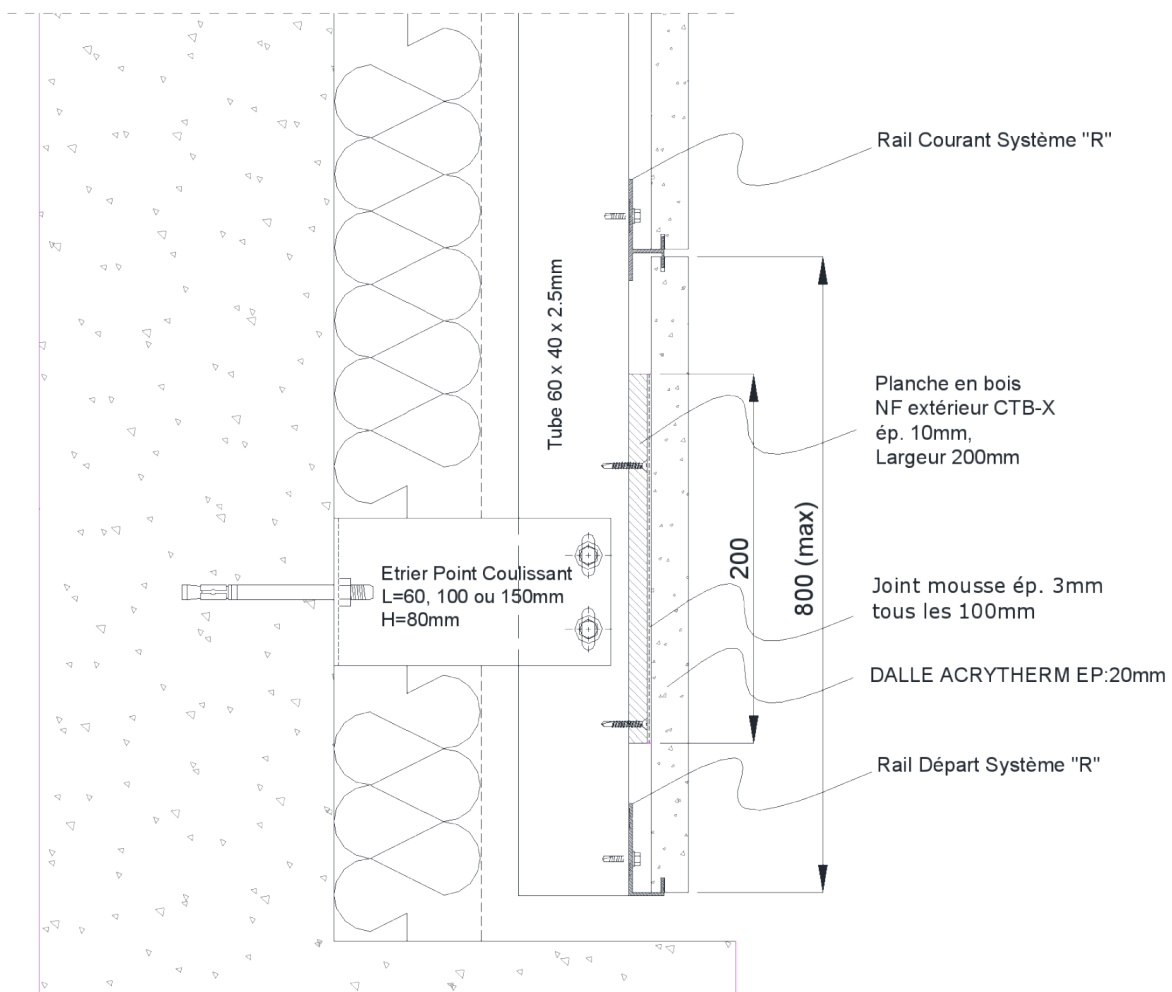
is – Coupe verticale – Plaque renforcée pour rez-de-chaussée exposés aux chocs extérieurs de classement Q4
